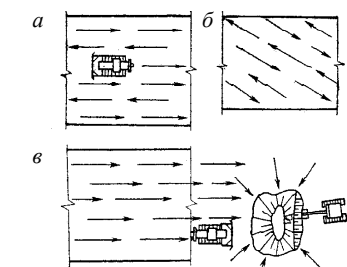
Схема разработки мерзлого грунта рыхлителем типа Д-652 при глубине промерзания до 2 м: а – 1-й этап – рыхление продольными проходами рыхлителя; б – 2-й этап – то же диагональными; в – 3-й этап – перемещение рыхленного грунта бульдозером
